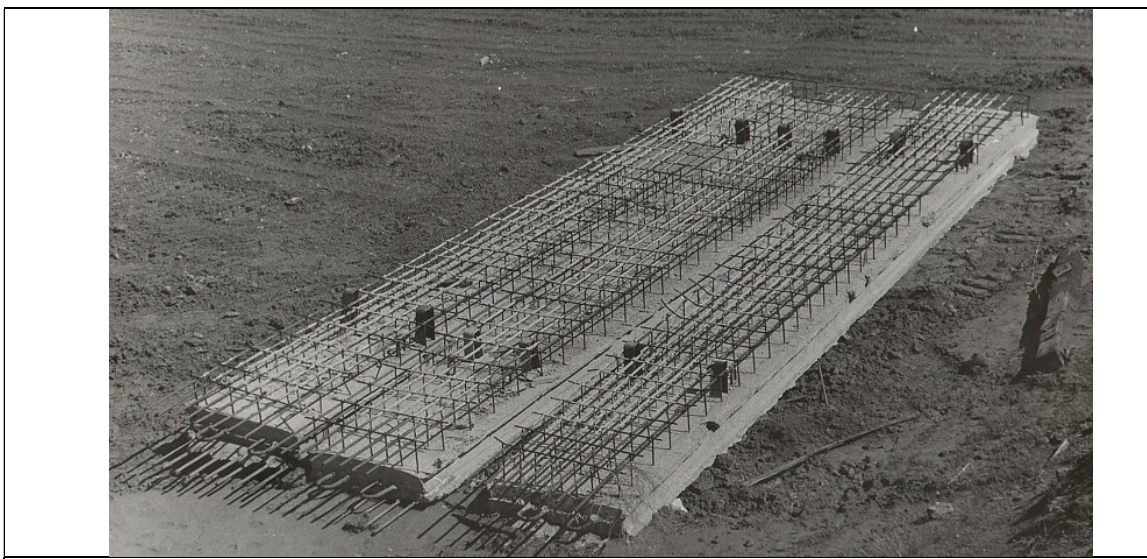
Готовые стеновые панели с выпусками арматуры для монтажа в траншею
